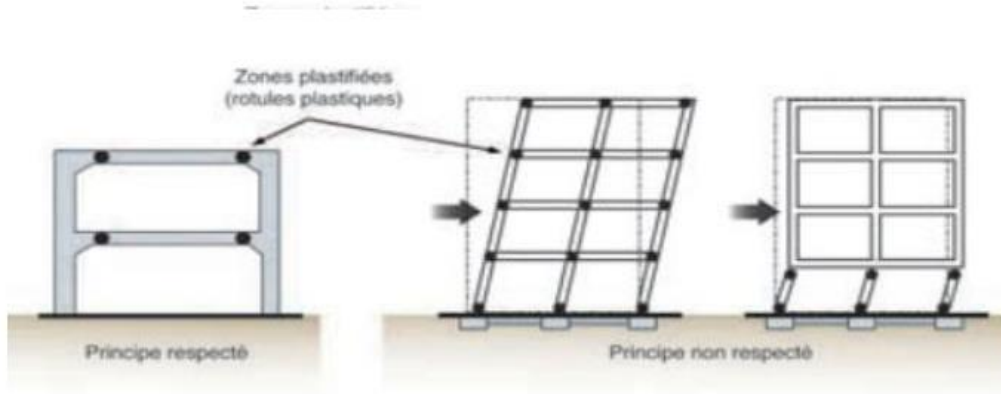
Principe poteaux forts - poutres faibles [27]
